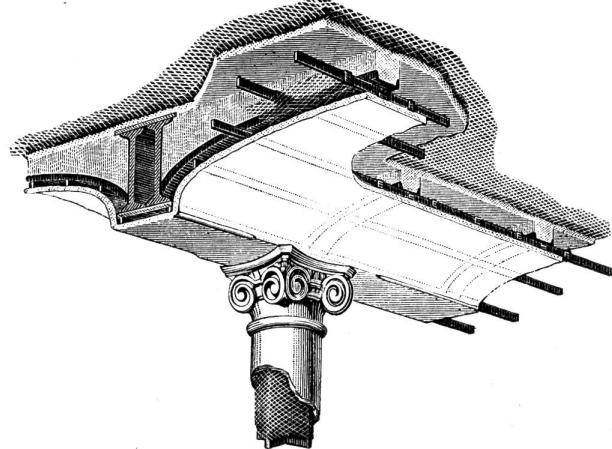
Kassettierte Decke mit Streckmetallbeton.
